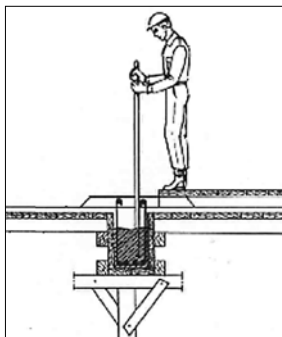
Sposoby układania mieszanki betonowej („ABC betonu” – wyd. Polski Cement)
